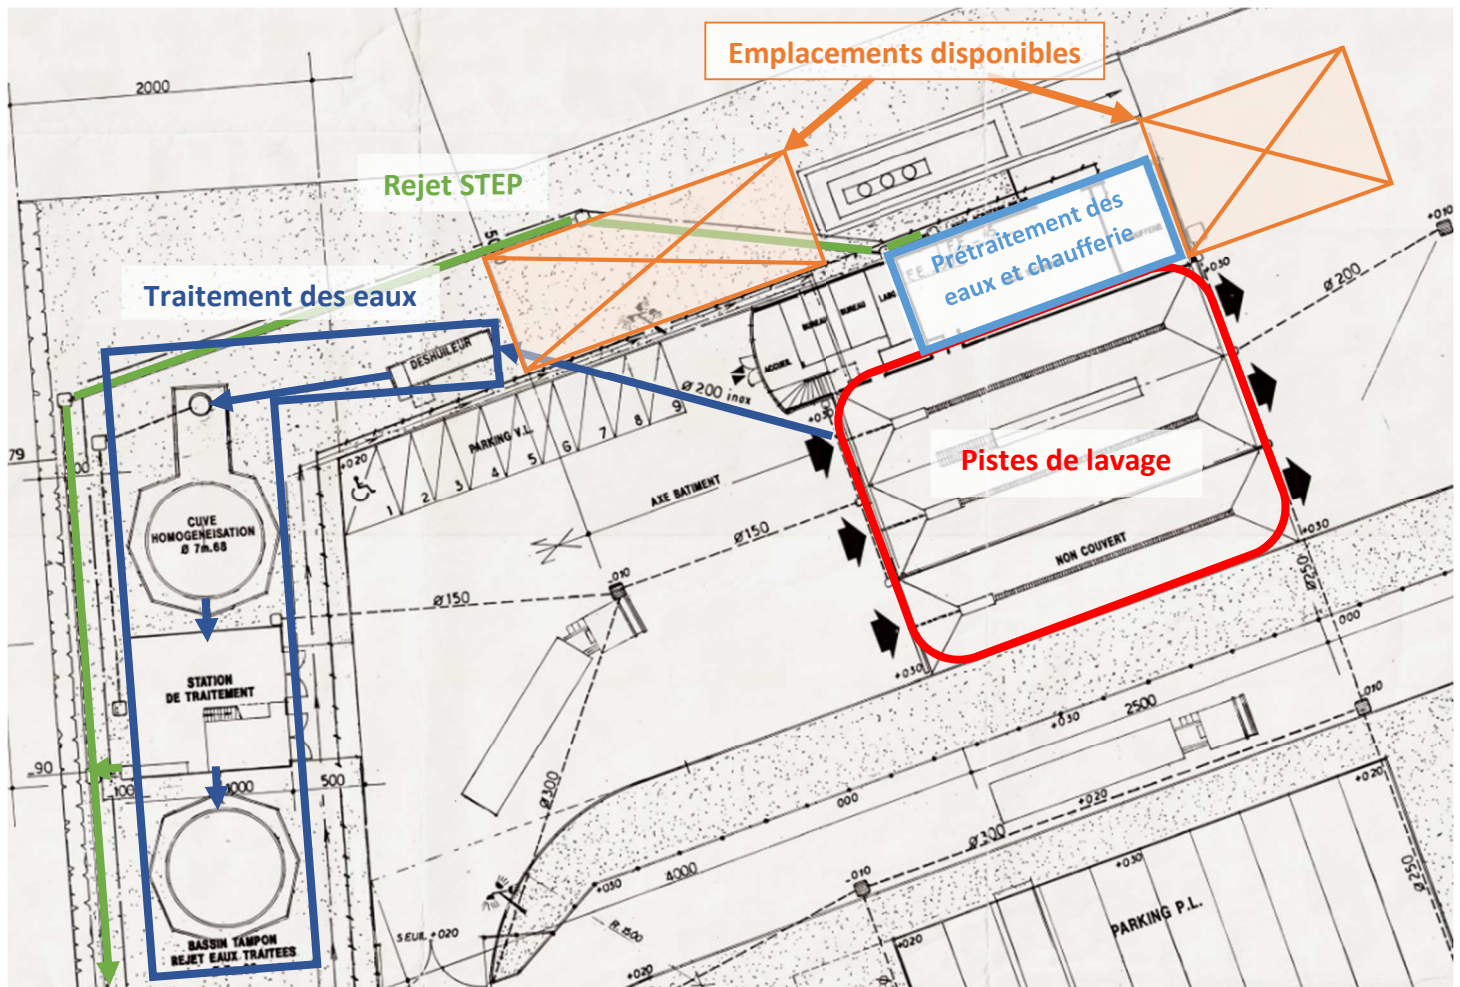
Plan d'ensemble du site XPO Tank Cleaning de Damparis
